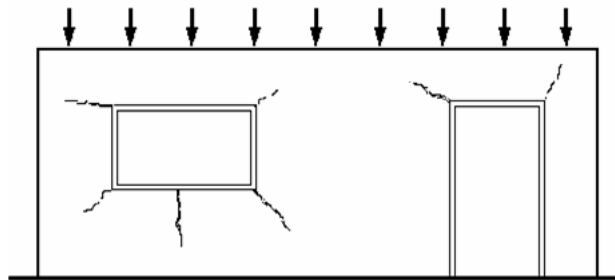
Representação de fissuras causadas pela ausência ou subdimensionamento de vergas e contravergas (SAHADE, 2005)
